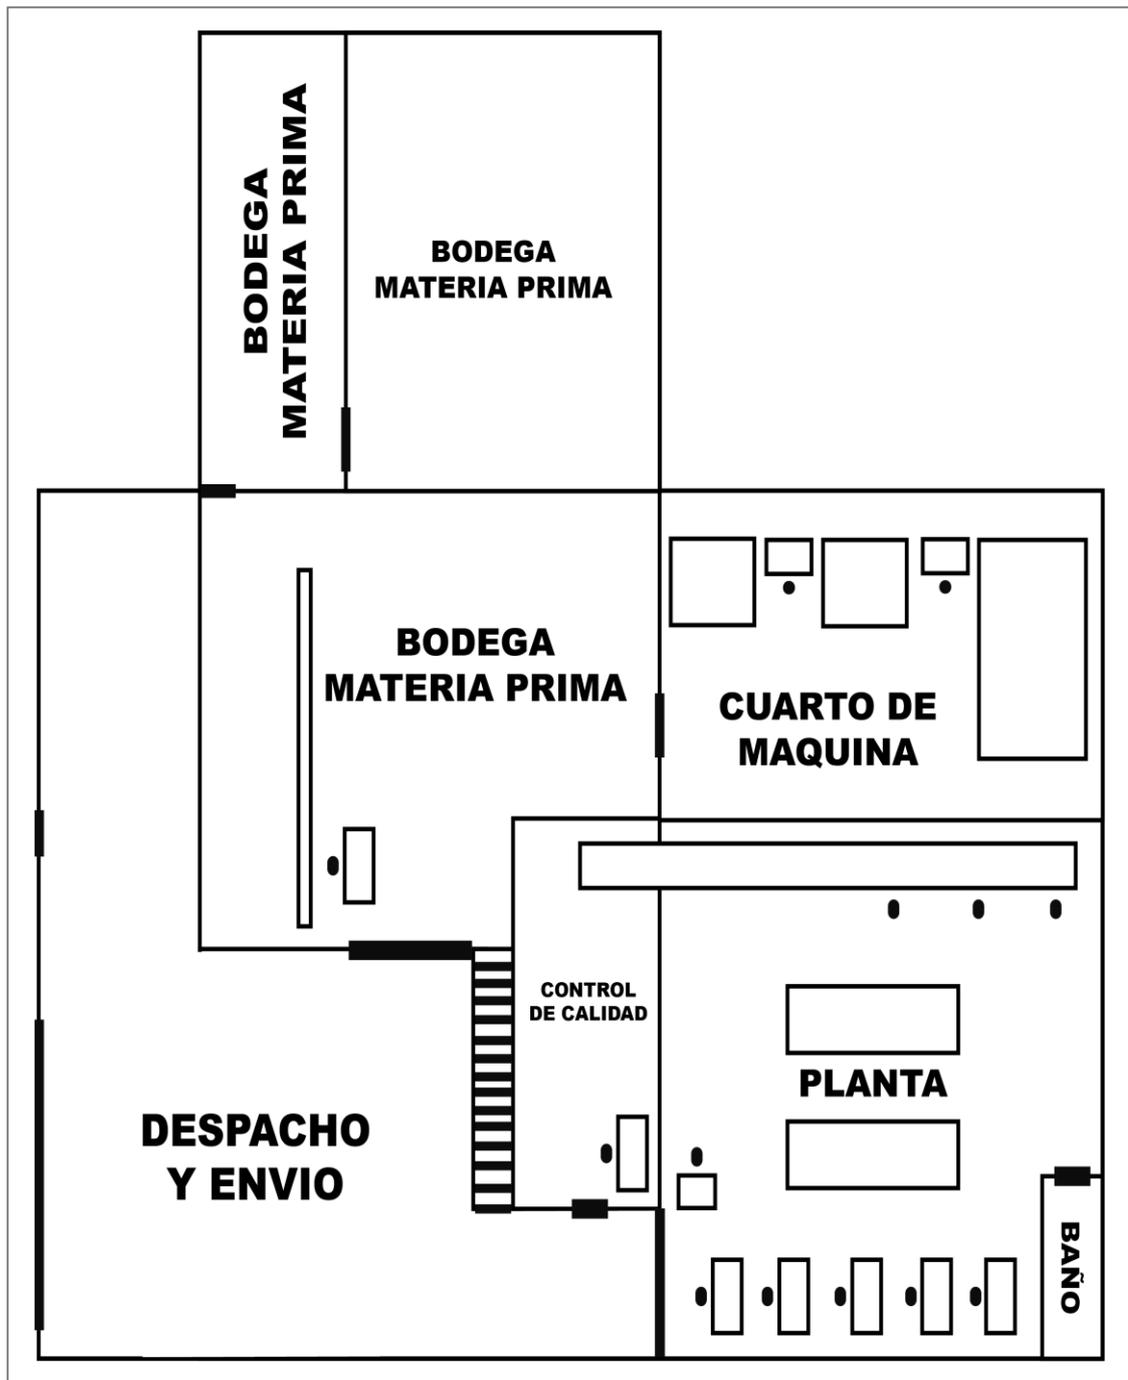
Layout de la planta baja de la Fábrica de calzado D'Dalis.
